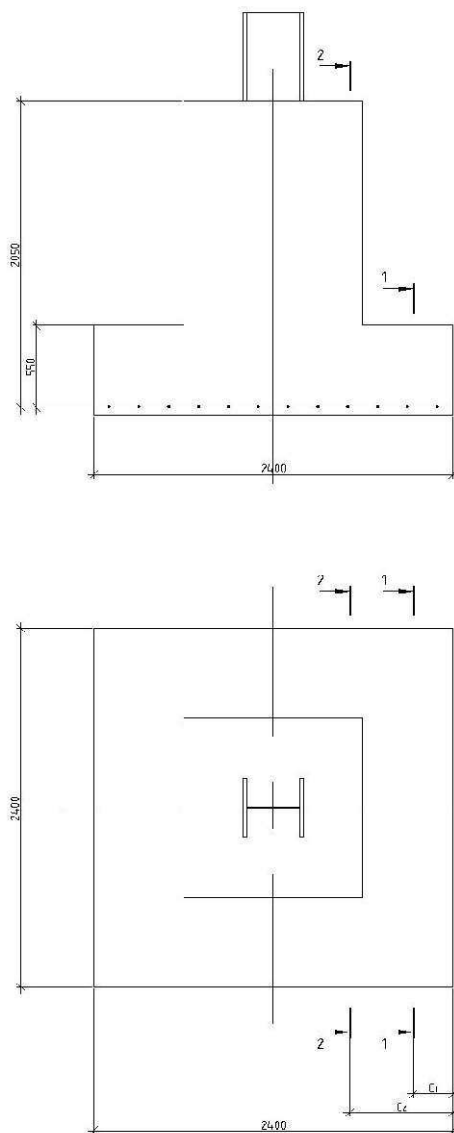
Расчетная схема и сечения для определения арматуры внецентренно нагруженного фундамента
